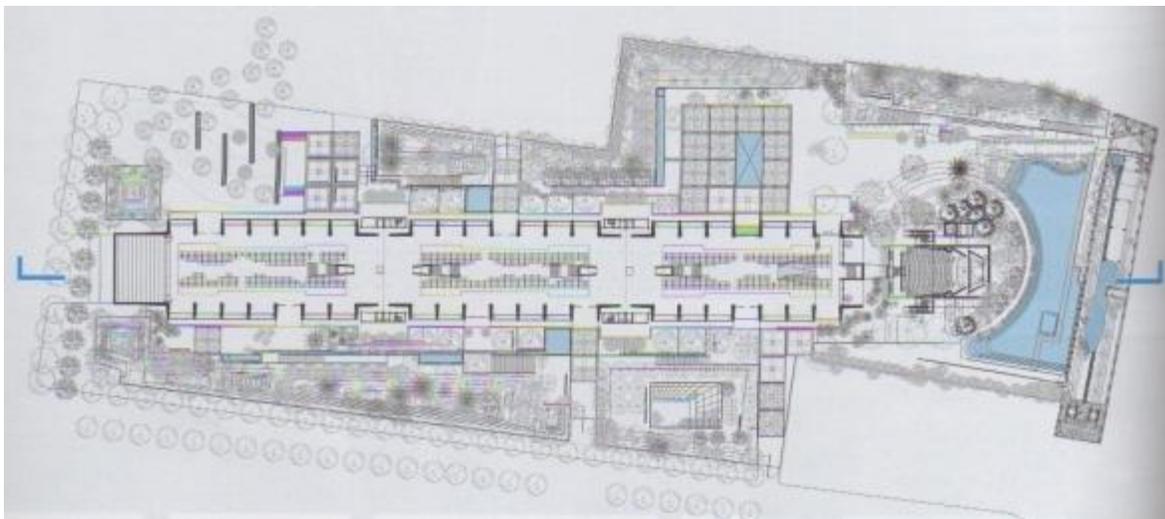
Planta de Conjunto. Fuente: Archivo AK.
